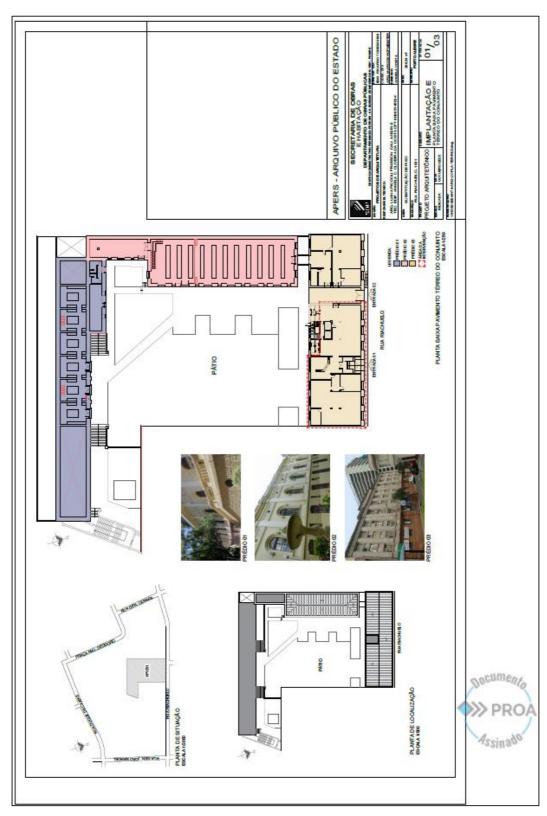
Levantamento fotográfico, conforme projeto aprovado constante na página 75 do PROA 19/1300-0004417-4.
